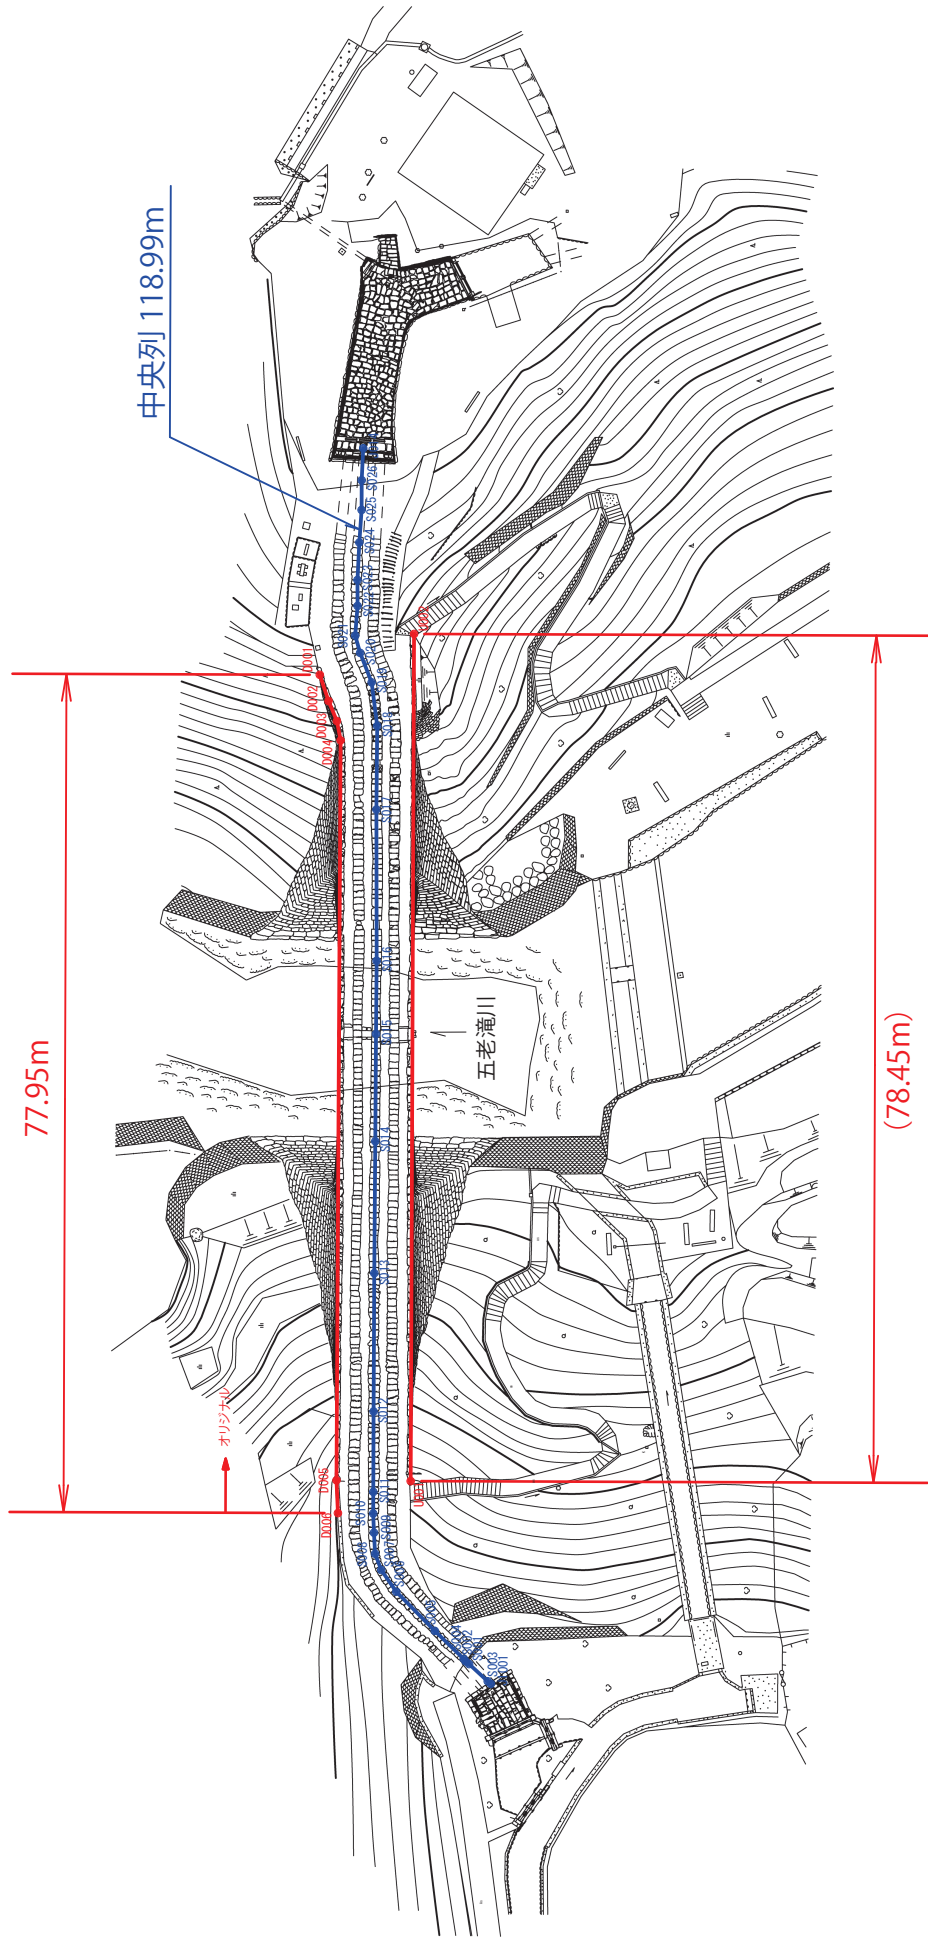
通潤橋計測図1 平面図 (S=1/700)
